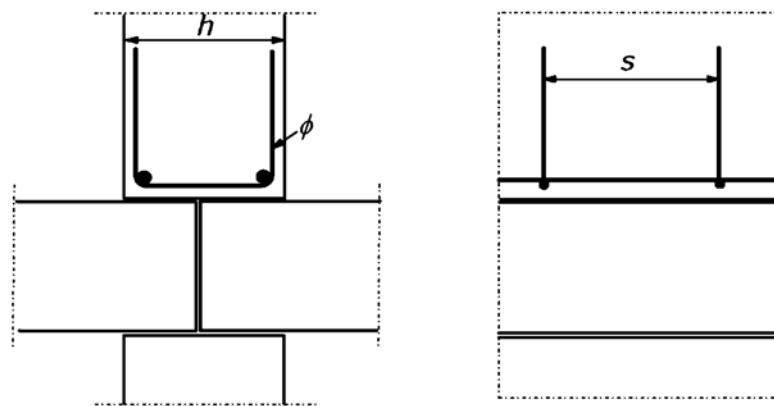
Приклади армування стіни над стиком між двома плитами перекриття
